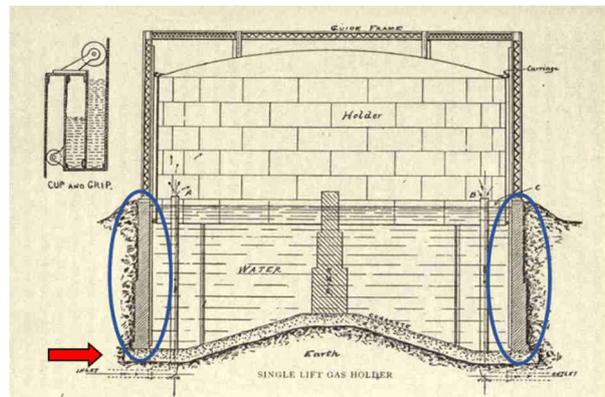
Esquema de construção de um gasómetro (in Trustees Gas Educational Fund, 1909: 313).
